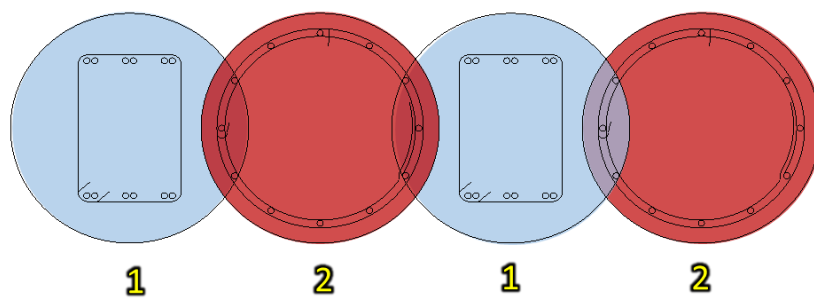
鹽水溪河川橋 80cm 密排樁 overlap 示意圖
